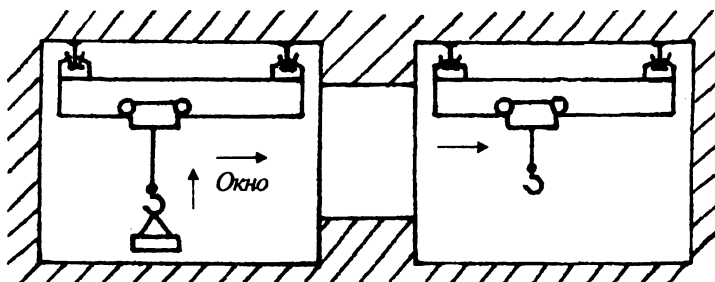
Схема передачи груза в соседний пролет подвесным краном
